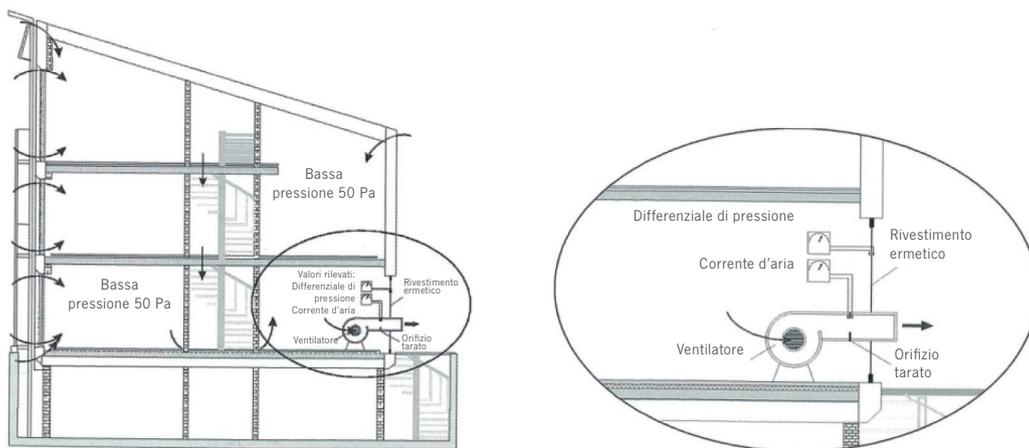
Schema di una misurazione BlowerDoor [7.3]
